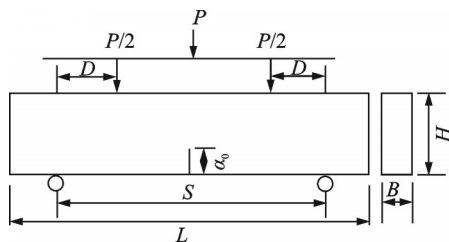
含预制微裂纹切口的混凝土四点弯曲梁计算模型 (单位:mm)
